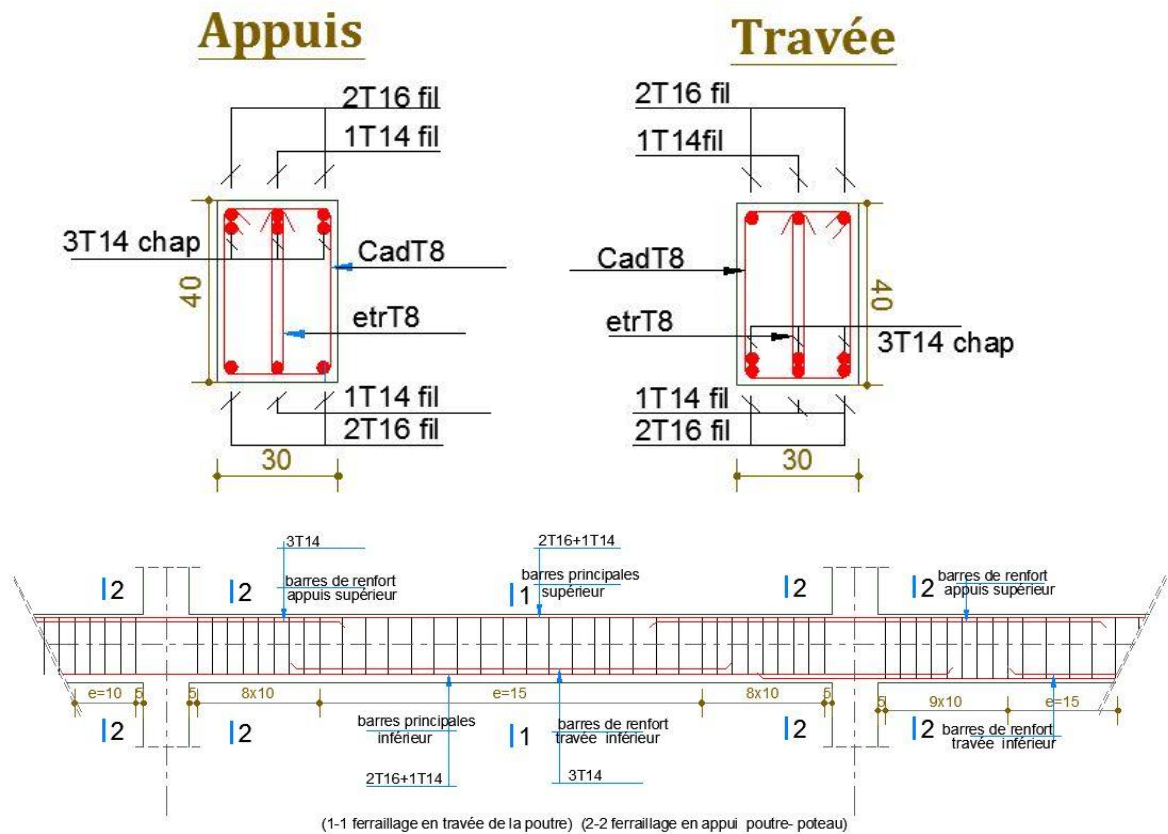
Schéma de ferrailage de la poutre secondaire.
